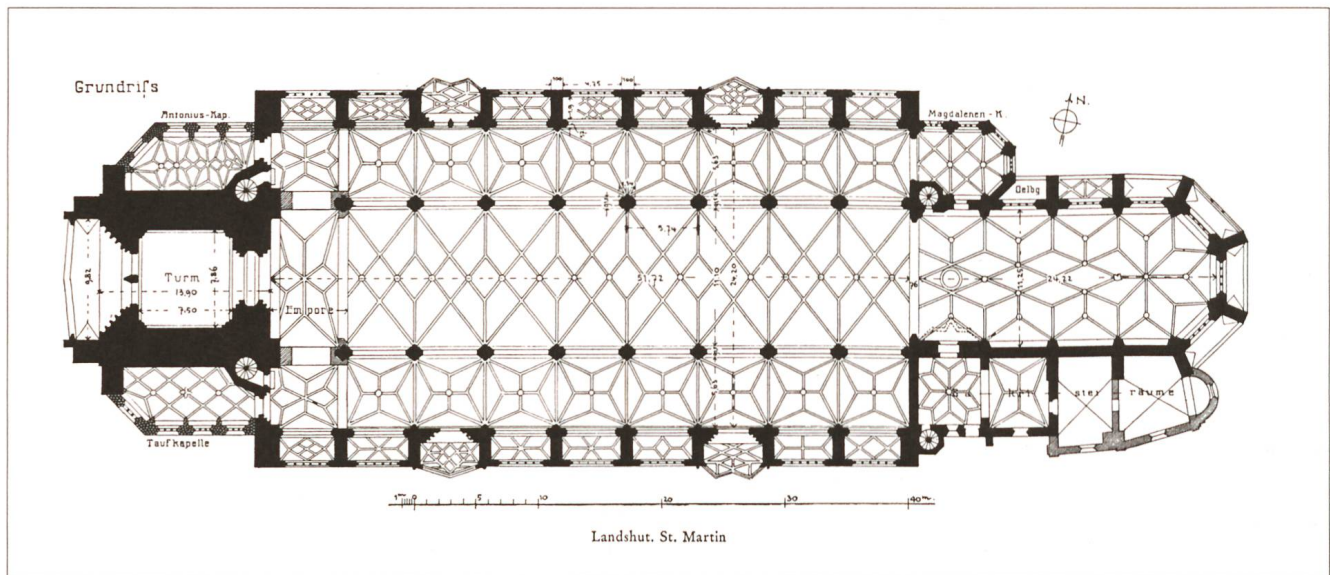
Grundriss der Stadtpfarrkirche St. Martin und Kastulus in Landshut (1385–1500).
